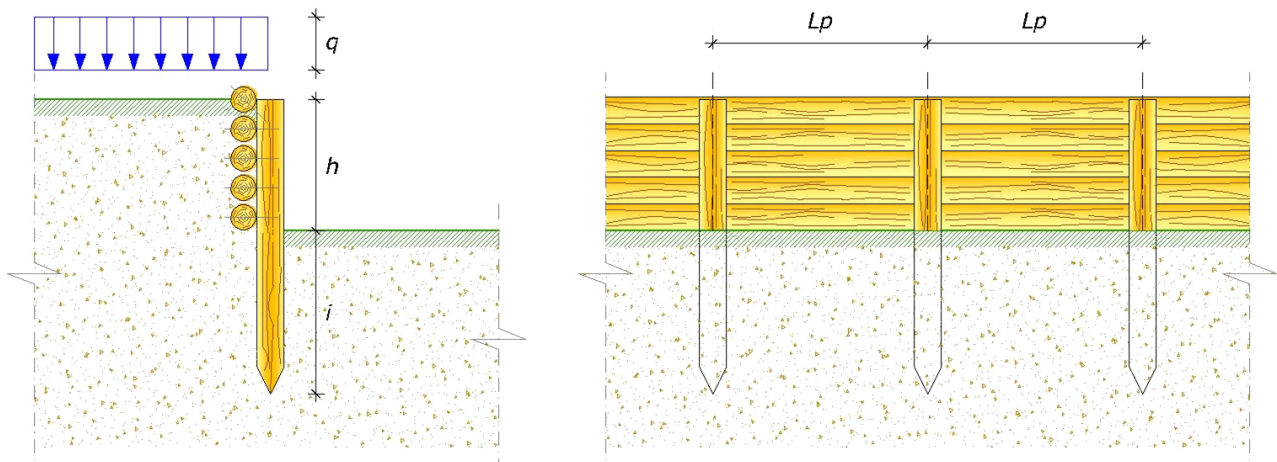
Sezione (a) e prospettiva (b) di una palizzata in legno.
